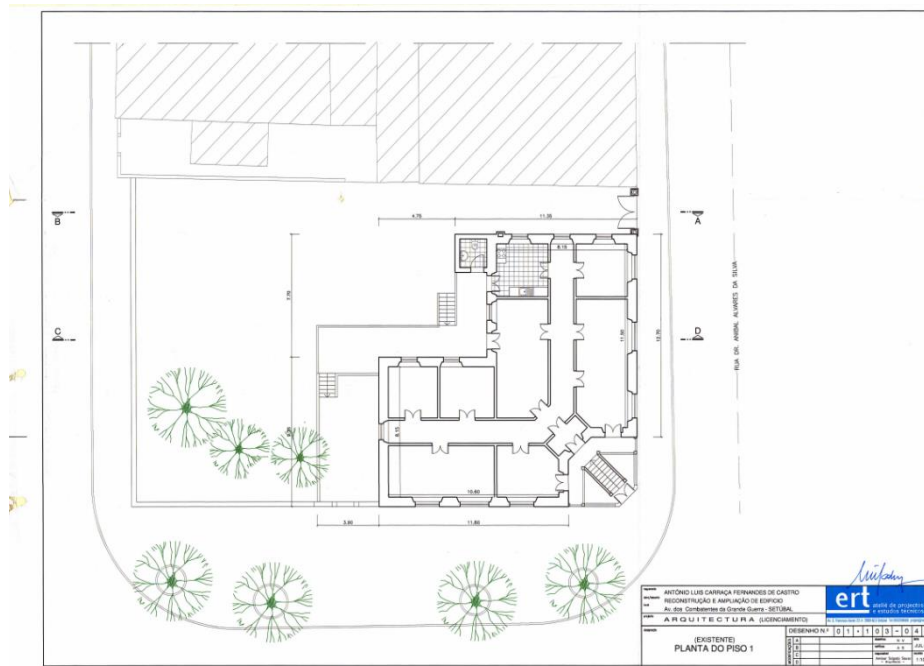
Desenho técnico da planta do piso 1. Fonte: ERT
